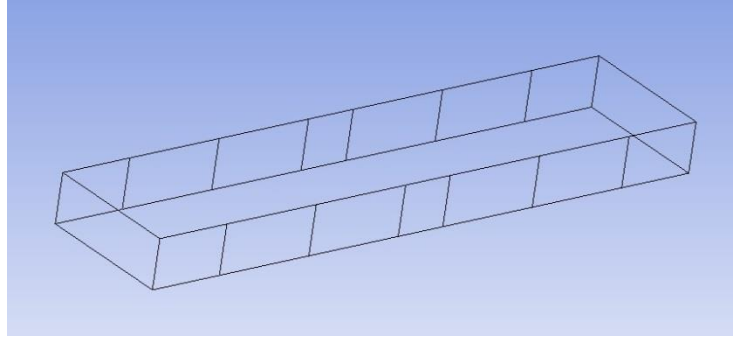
Elemento anelar estrutural construído no Design Modeler
